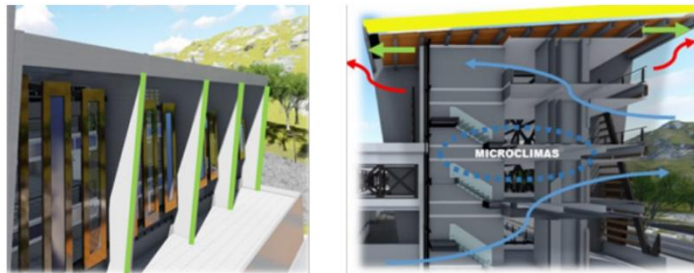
estrategias arquitectónicas para la protección solar. Fuente: elaboración propia.
